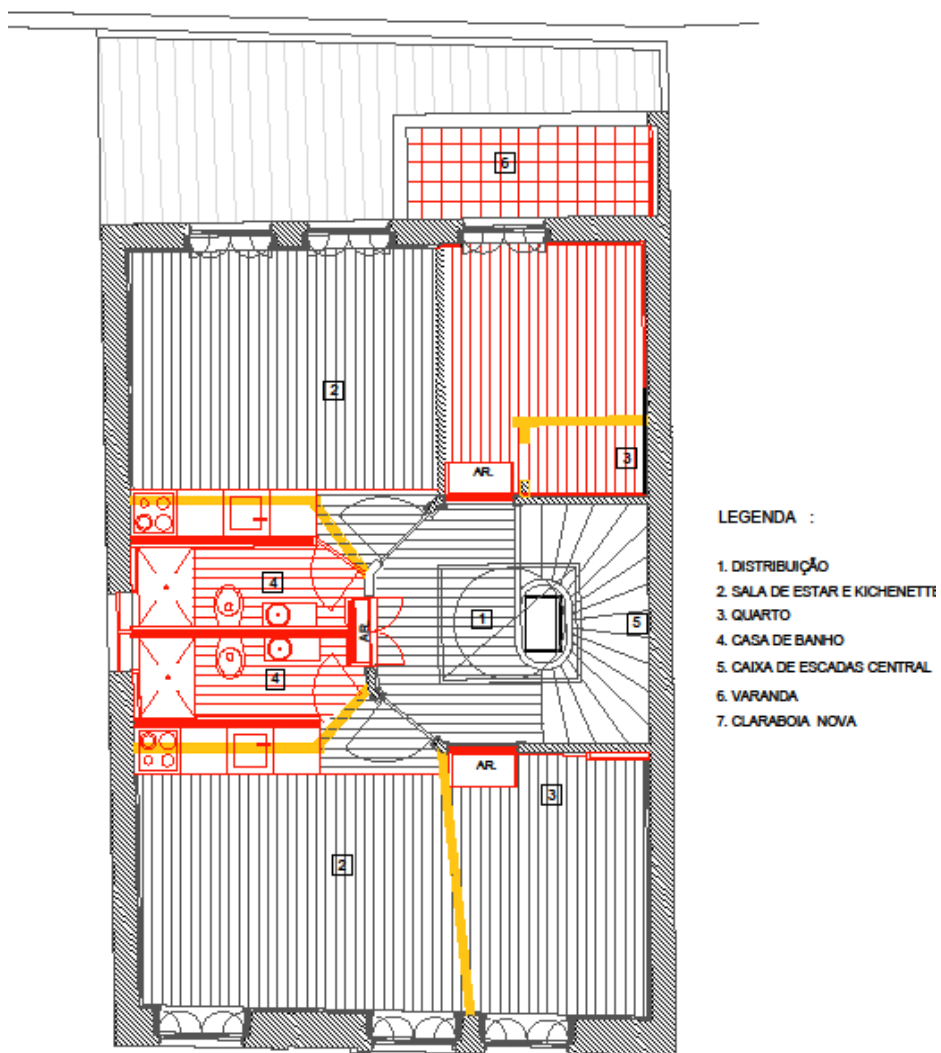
Planta vermelhos e amarelos do piso 1
